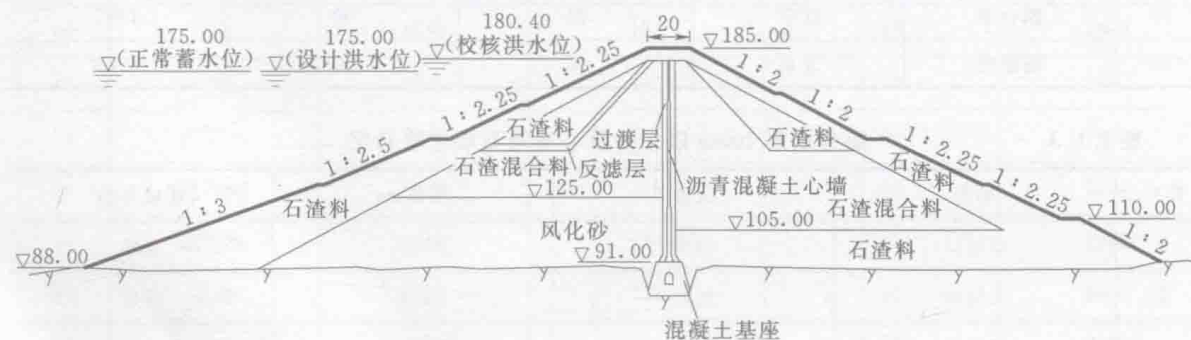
沥青混凝土心墙堆石坝典型横剖面及材料分区图 (单位: m)
